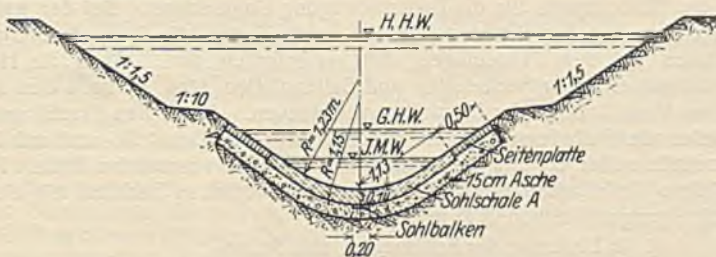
Regelquerschnitt eines mit Betonsohlschalen und Seitenplatten ausgelegten offenen Abwasserkanals. Oberhalb der Platten ist zur Erleichterung der Unterhaltungsarbeiten eine schmale Berme angeordnet. Die Platten werden in der Längsrichtung mit stumpfem Stoß verlegt und können bei Vertiefungen oder Aufhöhungen des Bachbettes leicht herausgenommen und wieder verwendet werden.
